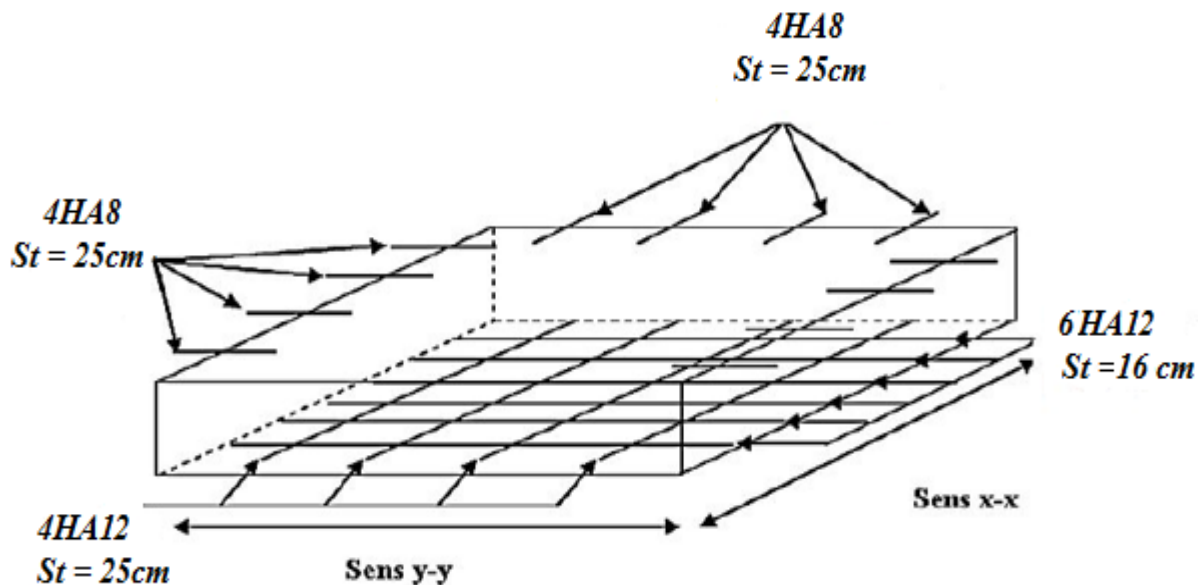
Schéma de ferrailage de la dalle sur un trois appuis
